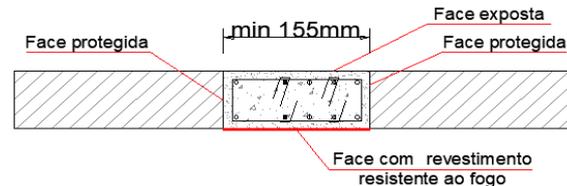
Dimensões mínimas para pilares com uma face exposta ao fogo.
